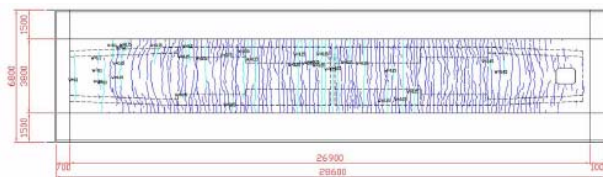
疲労による橋梁のひび割れ状況(平面図)
